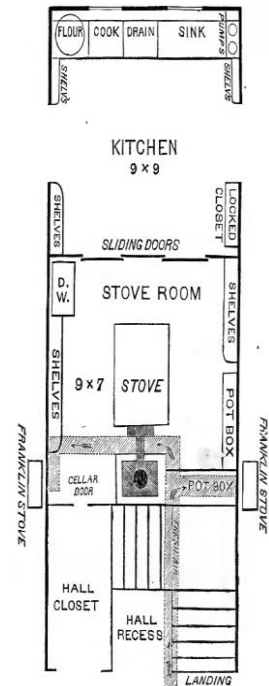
Proposta da planta de cozinha de Catherine Beecher
